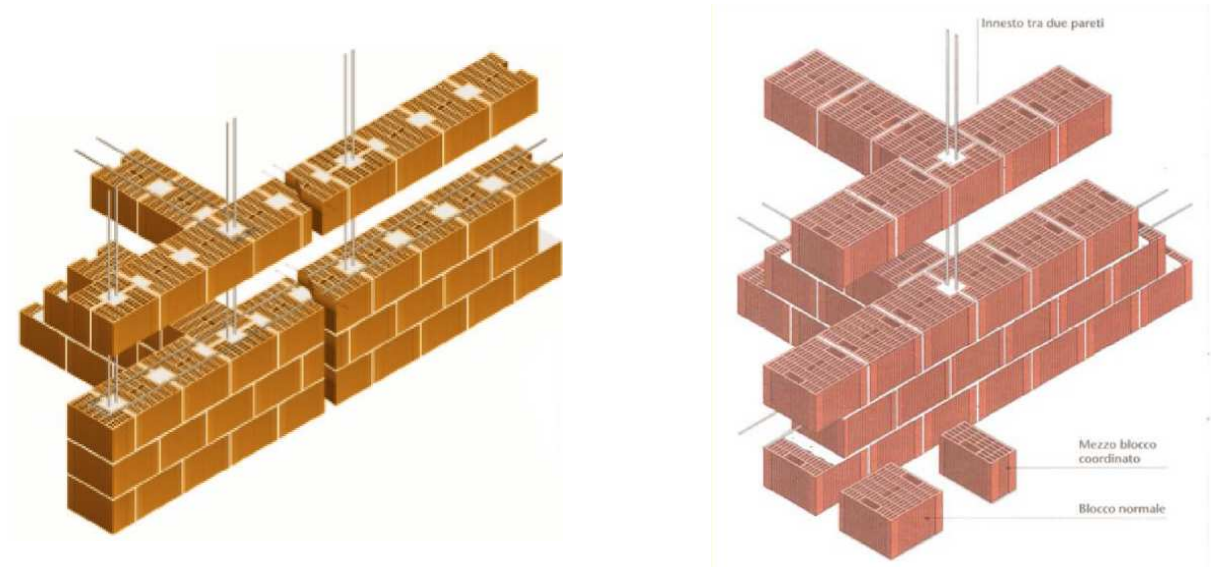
Particolare di innesto tra due pareti e zona terminale della muratura
